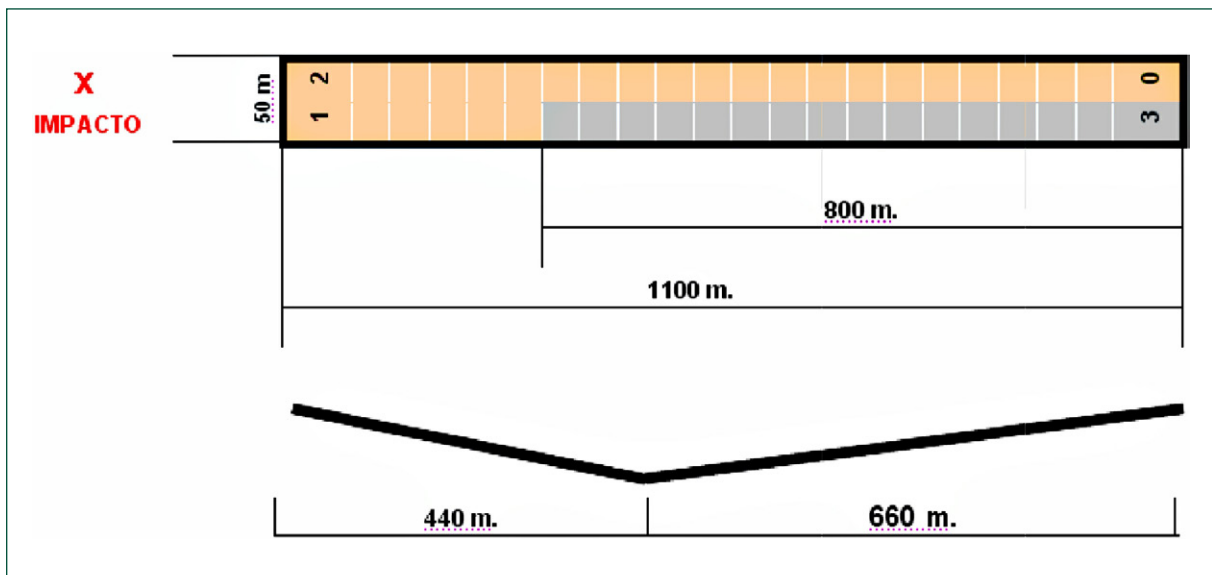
Planta y perfil de la pista 12-30 y punto de impacto
